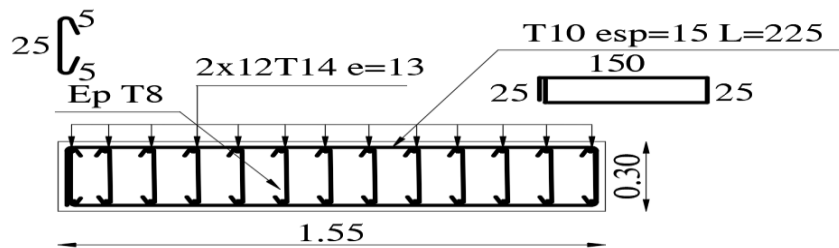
Schéma de ferrailage des voiles type 01.
